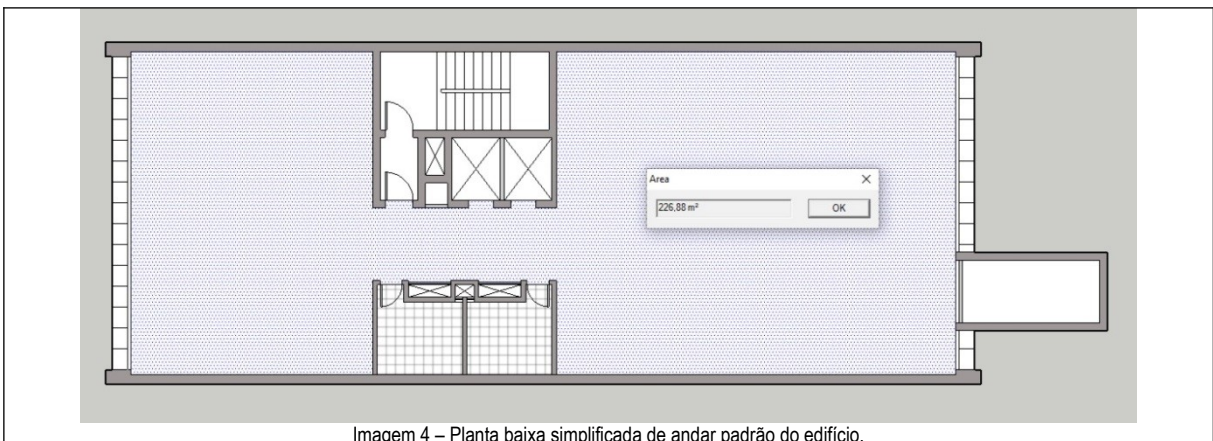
Planta baixa simplificada de andar padrão do edifício.
